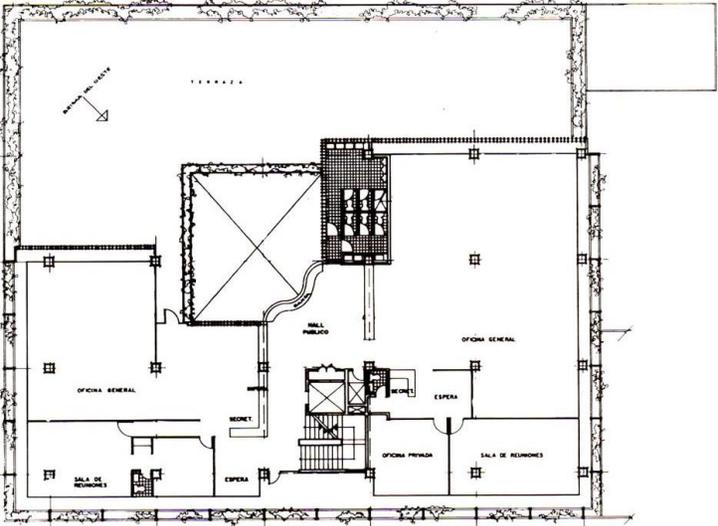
| Planta alta tipo. Fuente: Libro BAQ, 1980.
